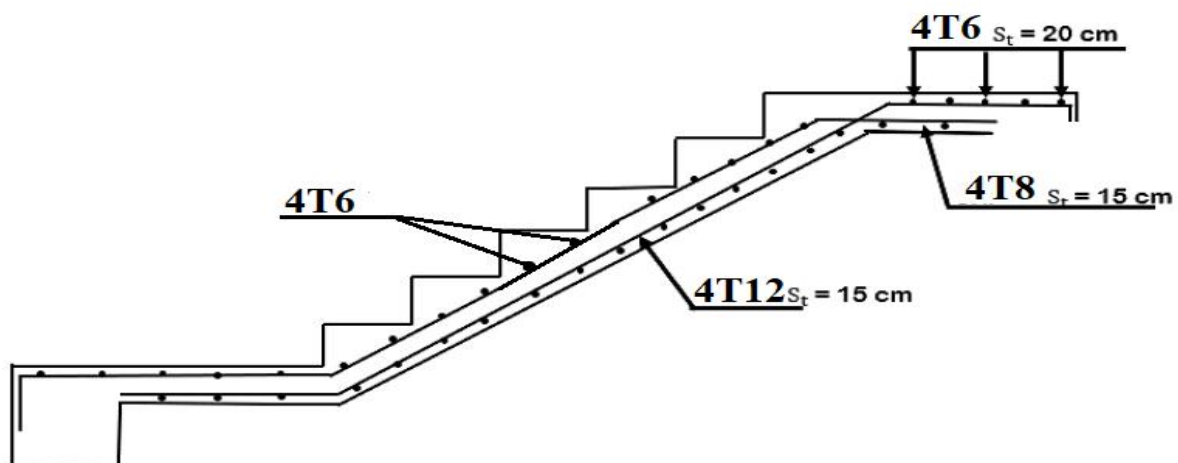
Schéma de ferrailage d'escalier type 2.
